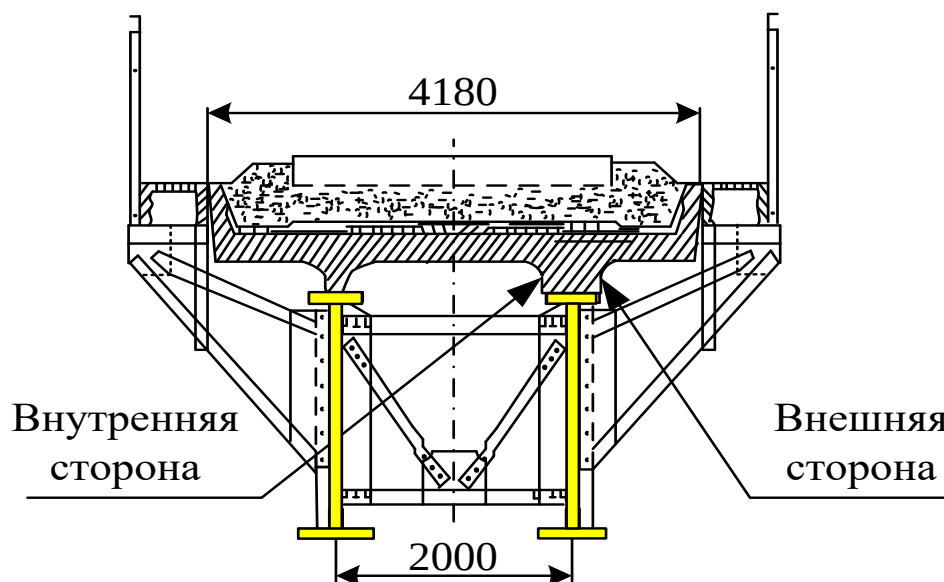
Поперечное сечение сталежелезобетонного моста, который расположен на перегоне Пидзамче – Львов, 1476 км ПК1 Львовской железной дороги
